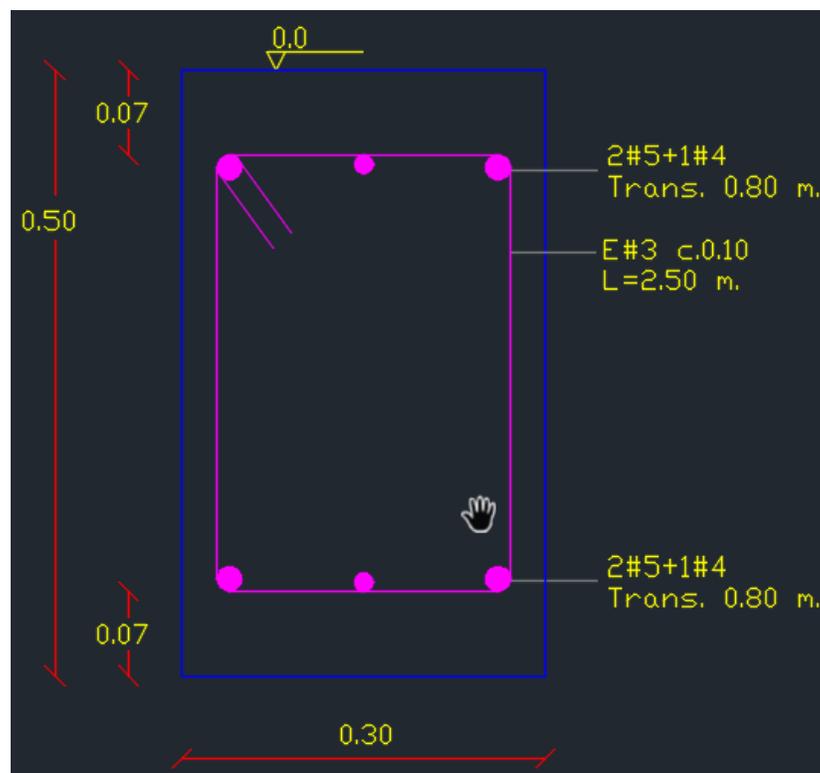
Viga de cimentación – Corte Z2-Z2. Fuente: Propia
